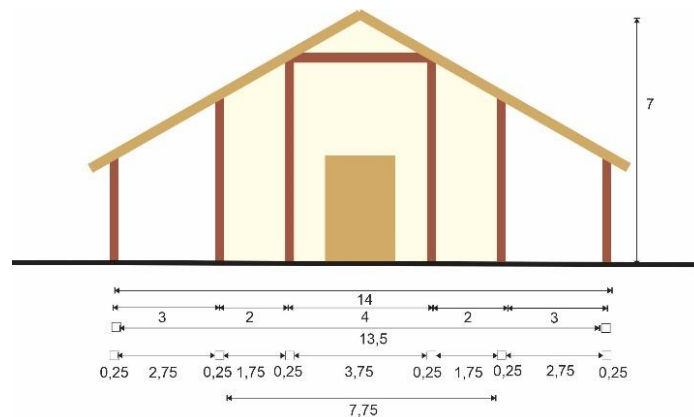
reconstrucción hipotética de la fachada de la capilla⁸
